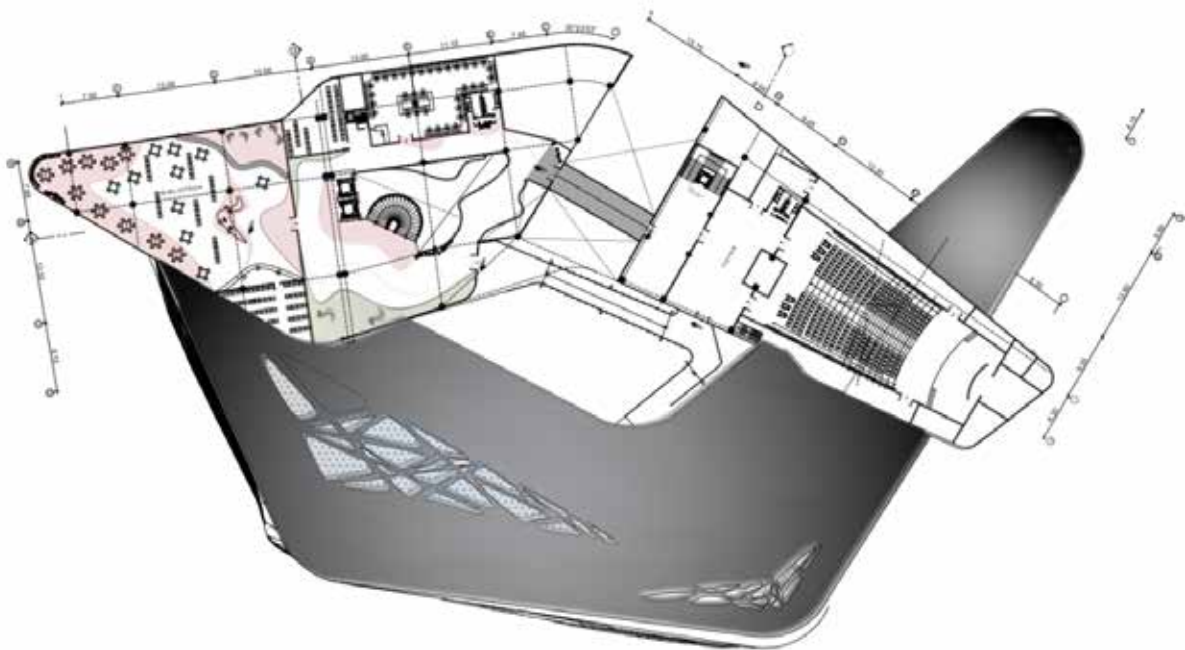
Plano Planta tercer piso de escuela de artes. (2017)
